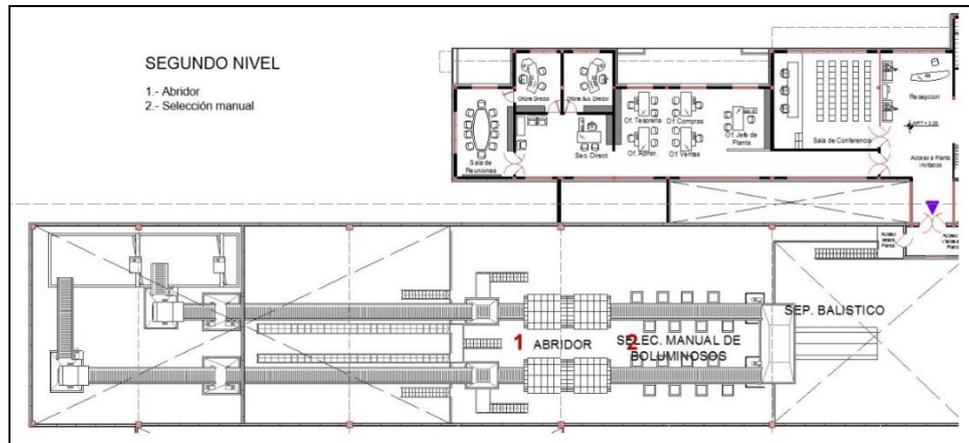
Distribución de 2 piso, Planta de tratamiento de “RSU” con producción de energías renovables- Empresa COGERSA. Fuente:
